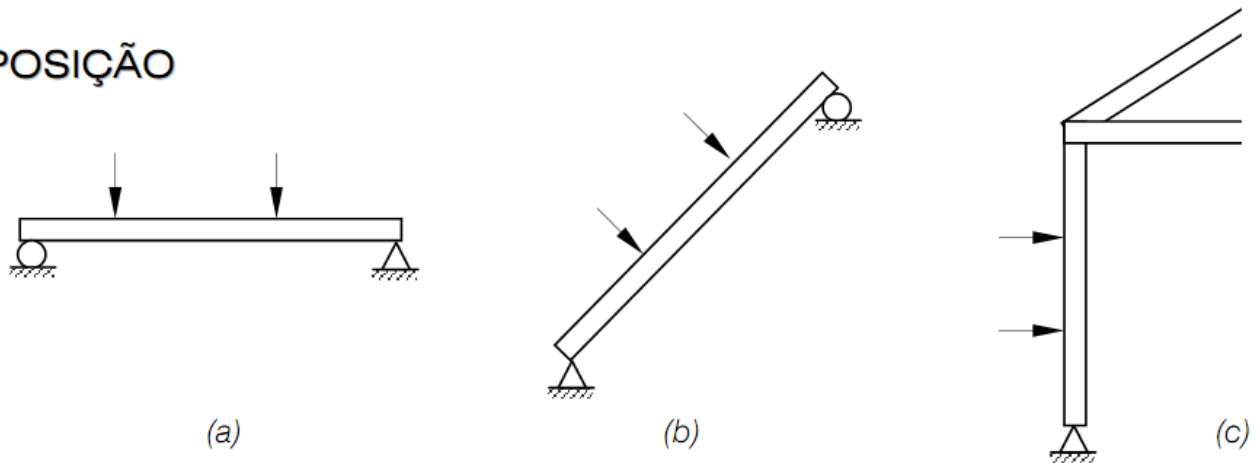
Vigas na posição (a) horizontal, (b) inclinada e (c) vertical.
